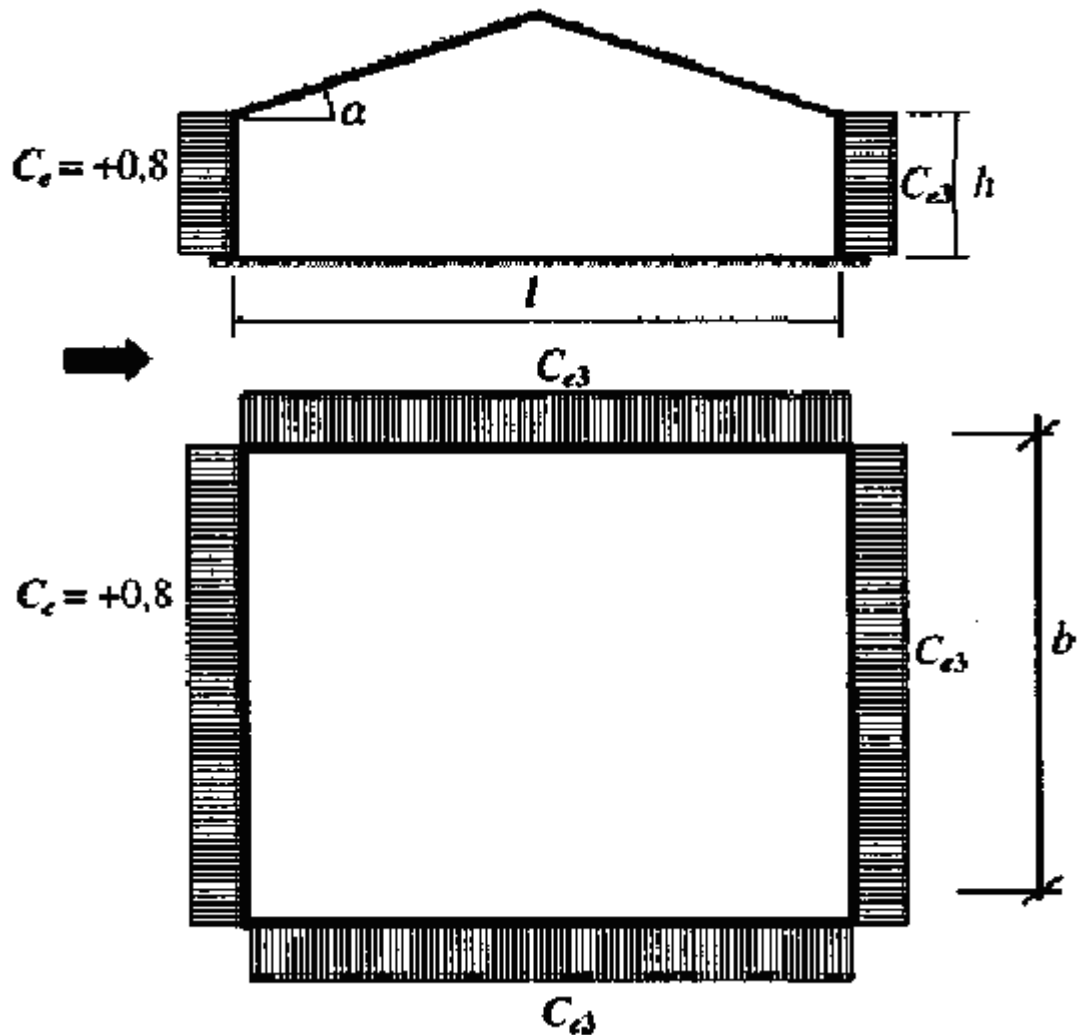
Схема вітрового навантаження для заданої будівлі
